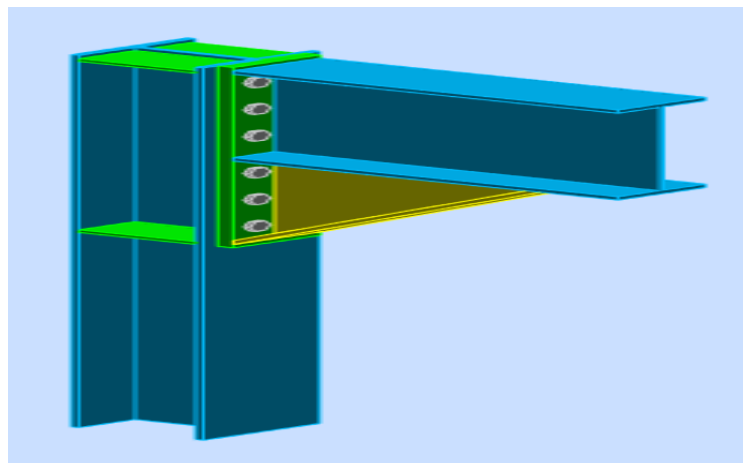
Vue 3D de l'assemblage poutre maitresse –poteau-plancher
